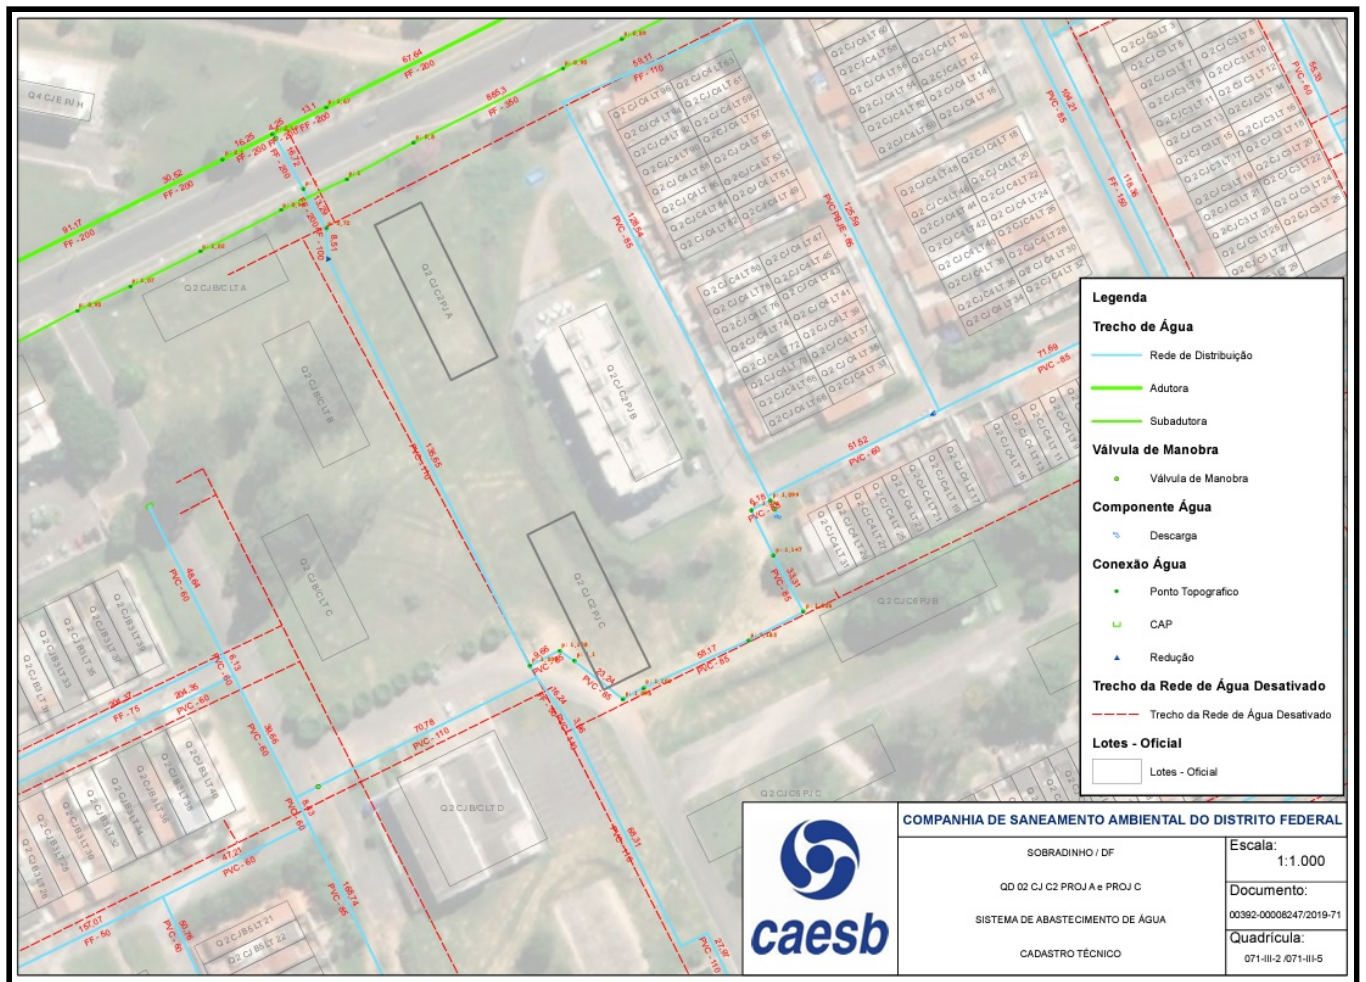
Planta Cadastral do Sistema de Abastecimento de Água de trecho da Quadra 02 da cidade de Sobradinho, que abrange todo o Conjunto “C2”. Fonte: Caesb.
